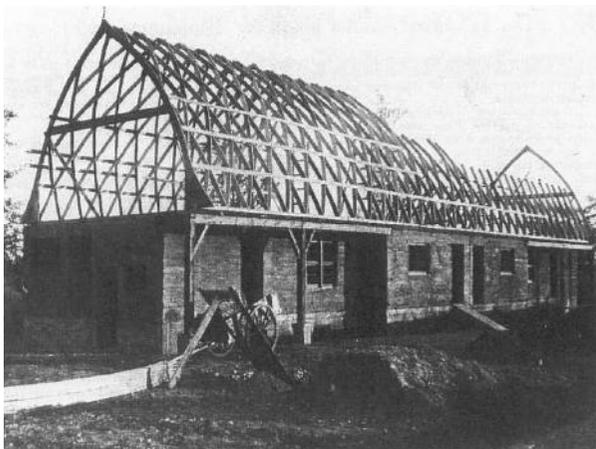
Doppelhaus mit Zollbau-Lamellendach in Merseburg (1922)
